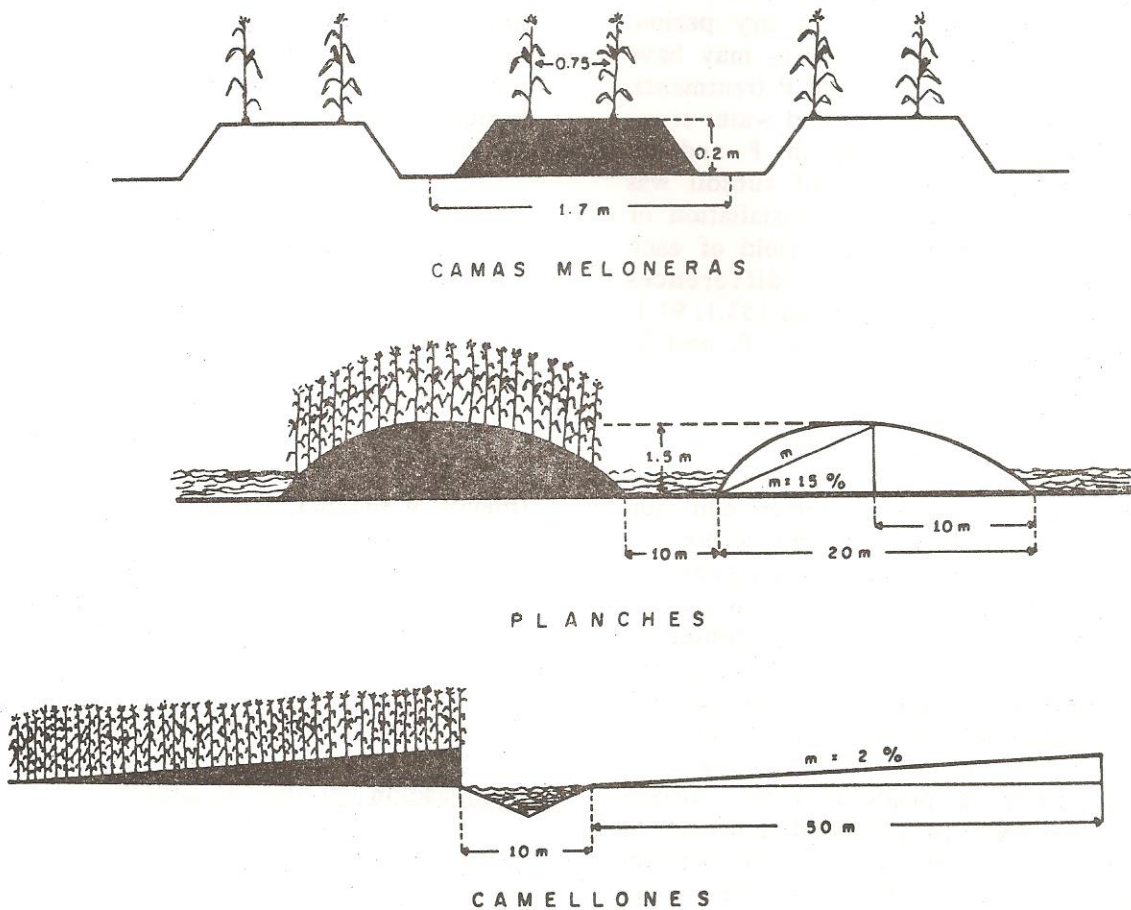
Representación esquemática de tres sistemas de drenaje superficial de suelo. Las estructuras no están a escala.
